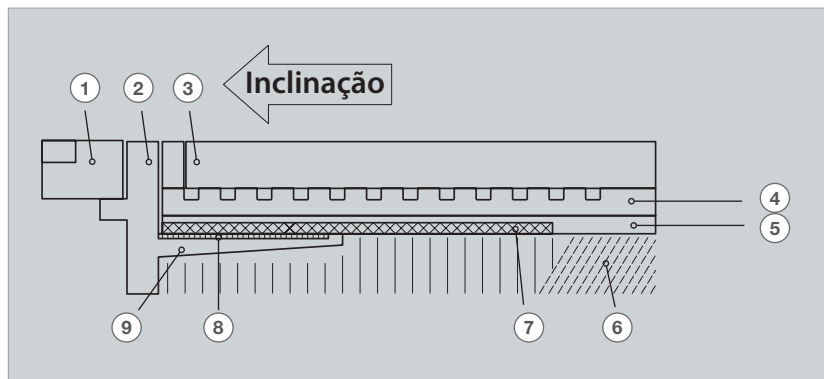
25 Impermeabilização líquida – Estrutura
